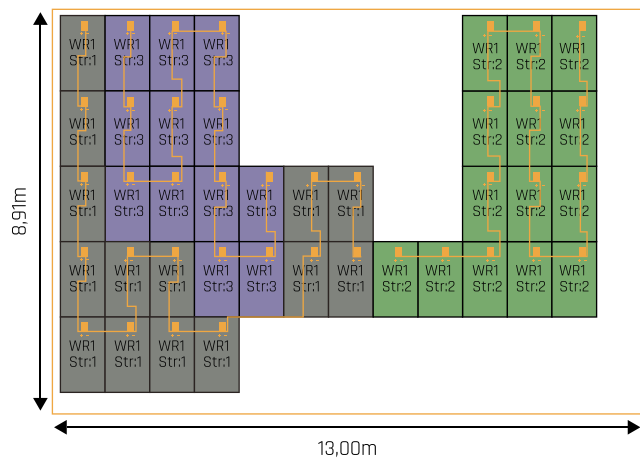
Planilha de string de um sistema FV de 9,6 kW.
